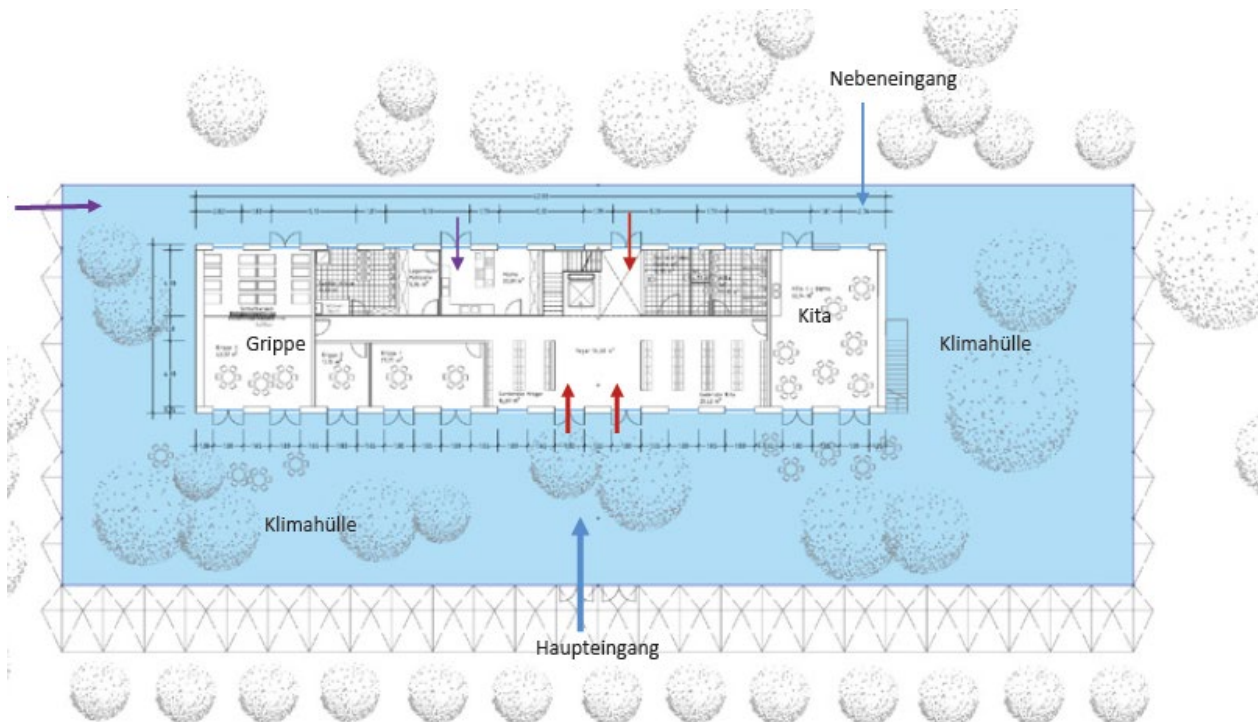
Grundriss Neuplanung der Klimahülle am Standort für Kita Neubau
